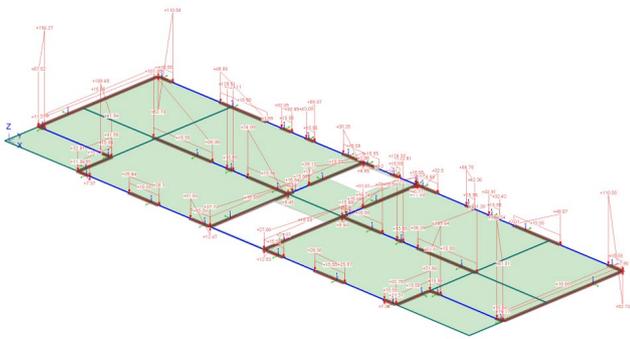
Geschossdecke als 2D-FE-Modell mit Belastungen aus den Lagerreaktionen der oberhalb liegenden Geschossdecke
